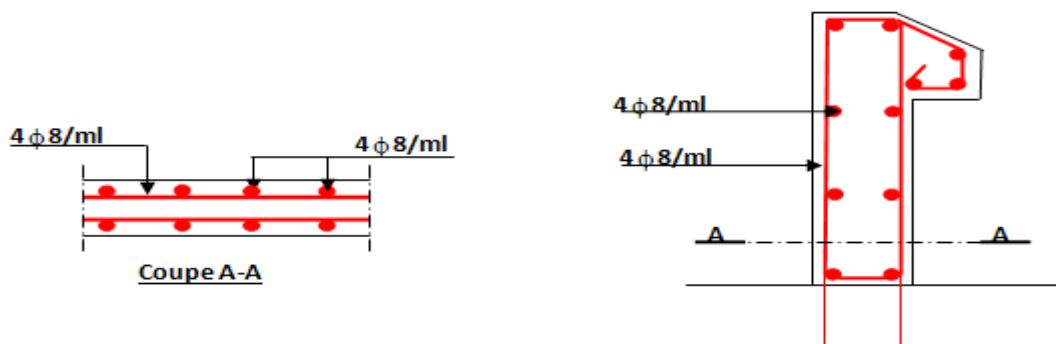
Schéma de ferrailage de l'acrotère (Terrasse inaccessible).
